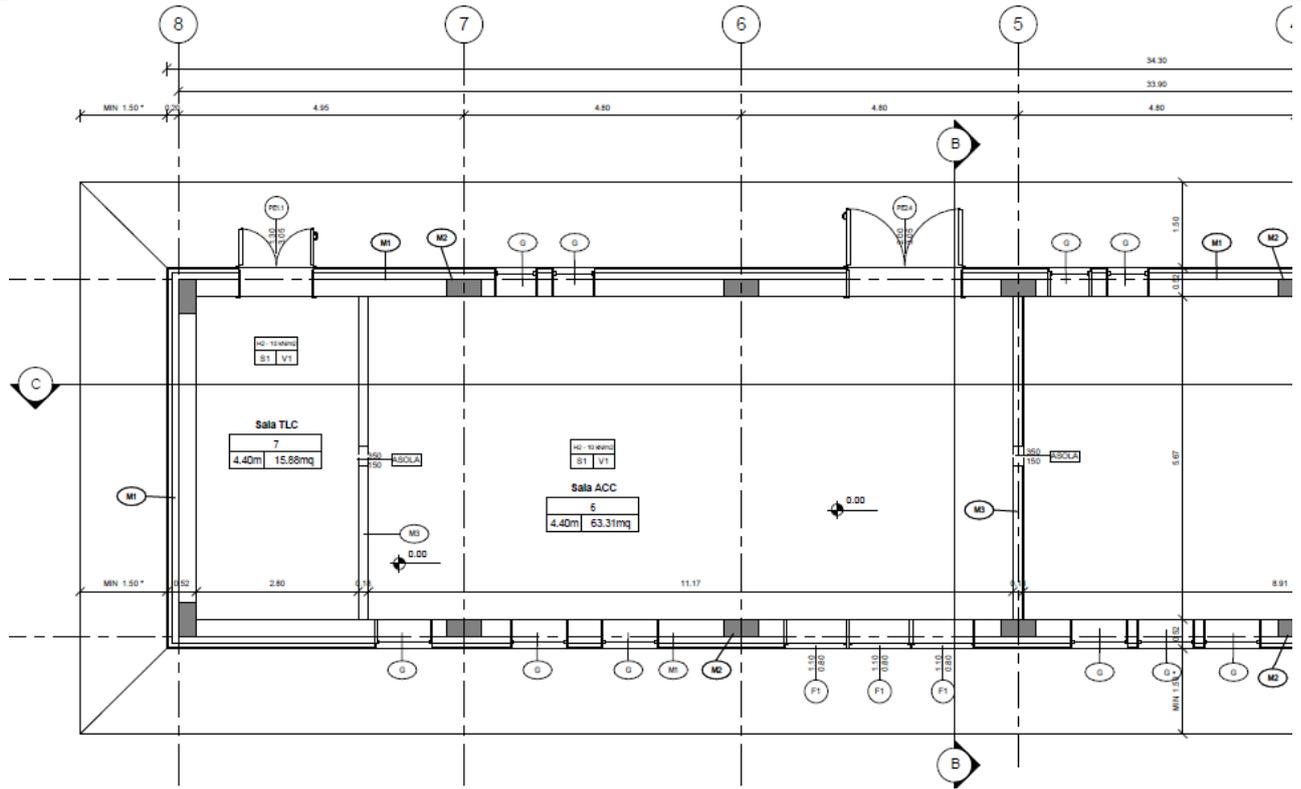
Pianta Architettonica Piano Terra T3_B
